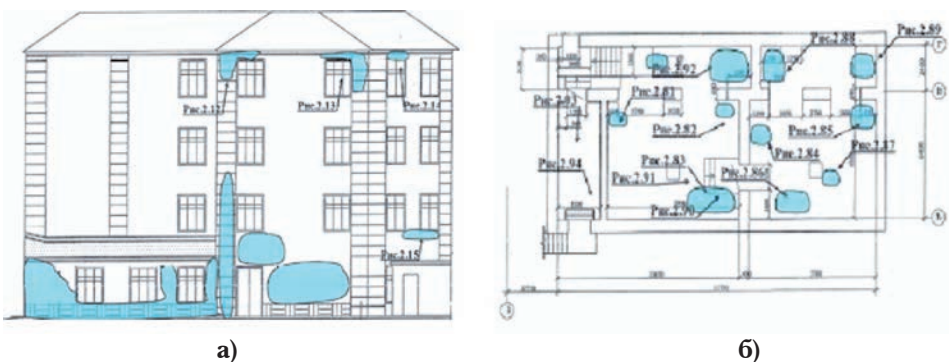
Фрагменти обстеження будівлі, з фіксацією дефектів та пошкоджень: а) – фасад в осях А – Е; б) – план підвалу
